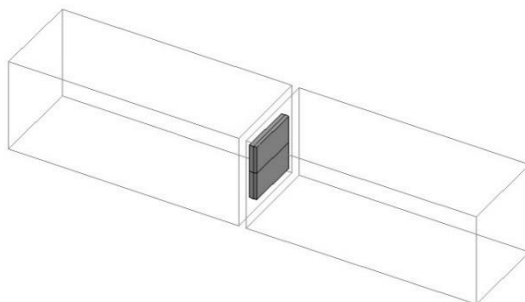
Ligação Viga – Viga por chapas metálicas verticais
